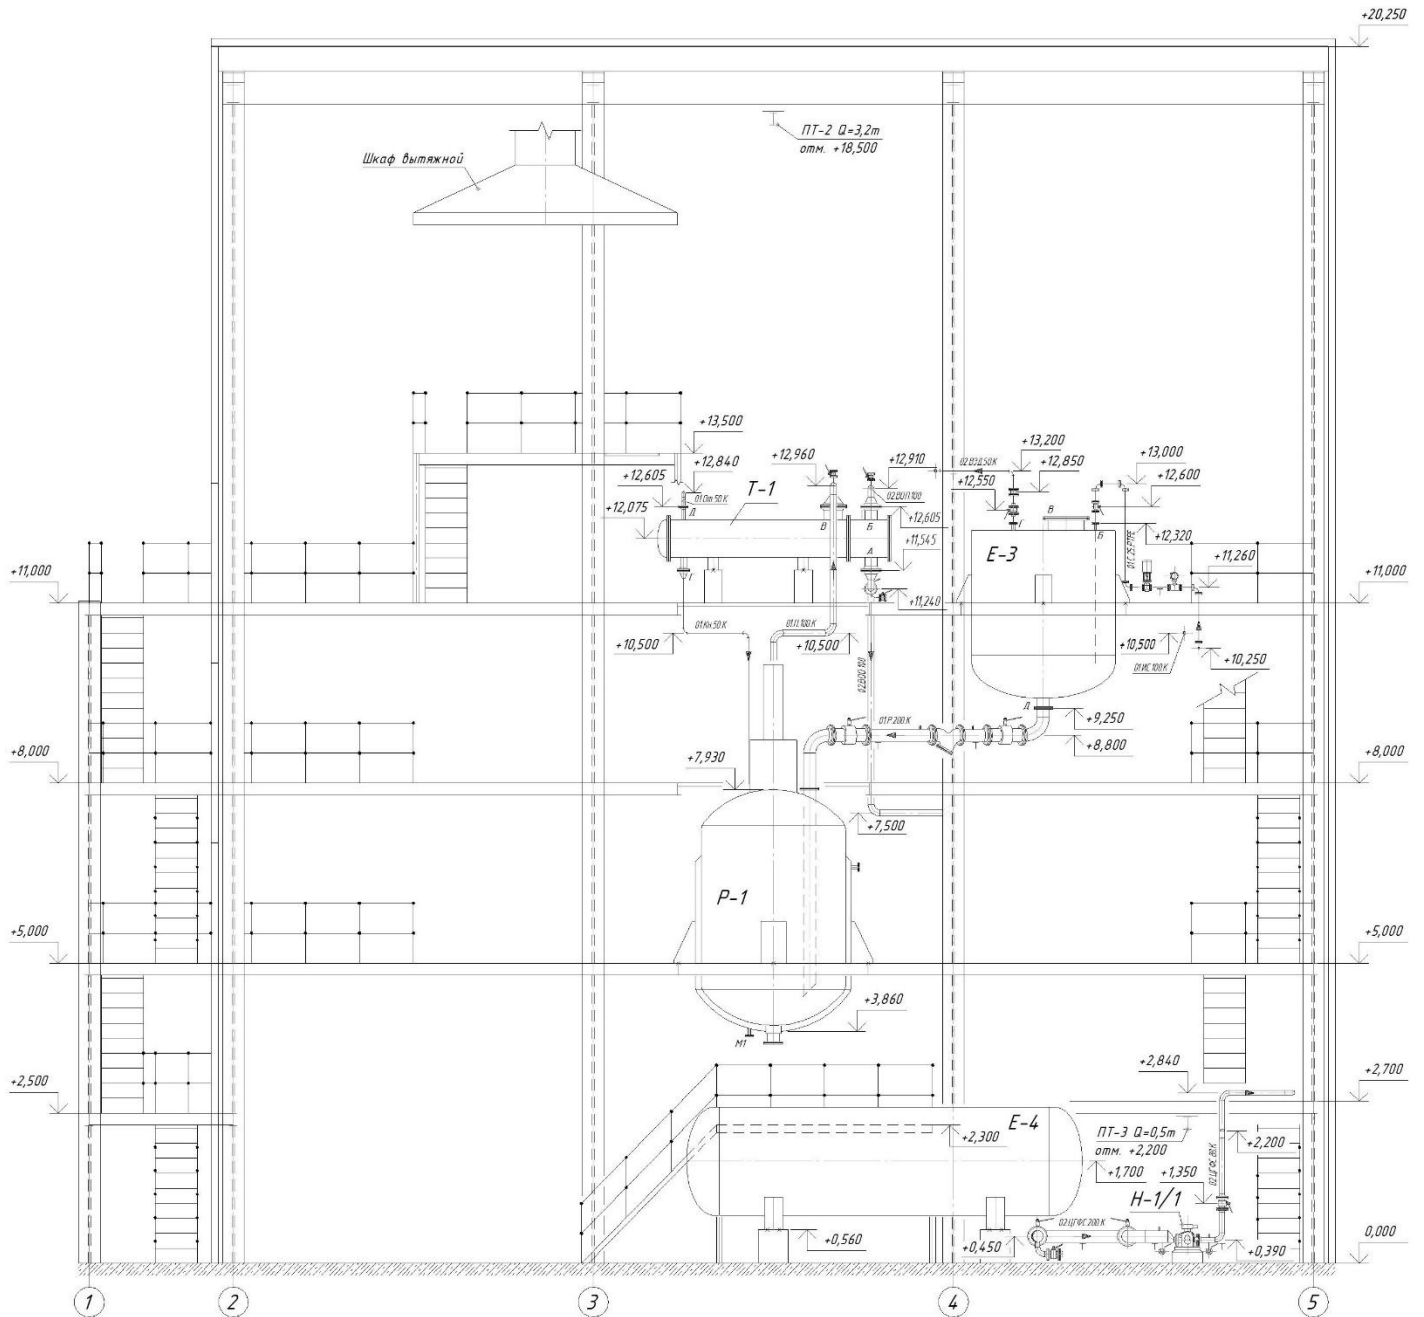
Монтажный чертеж обвязки оборудования разрез Б-Б
